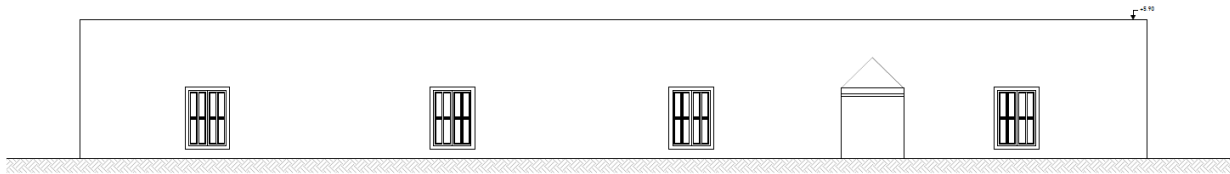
Alzado Oeste de la Biblioteca. Levantamiento realizado en el año 2019. Fuente: Autora. Ver Planos en los Anexos.
